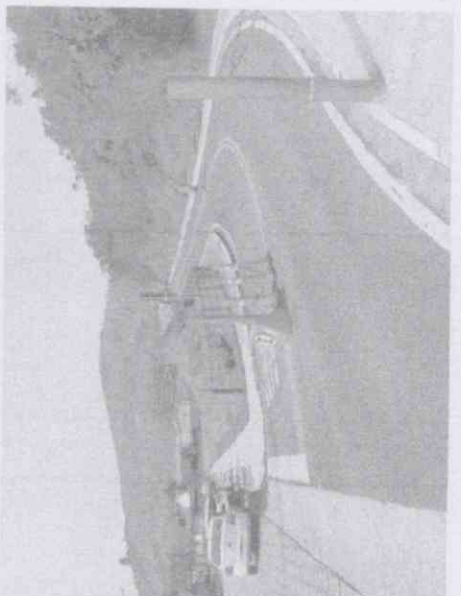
VISTA DA RUA DO MIRANTE DO CAMAROEIRO
